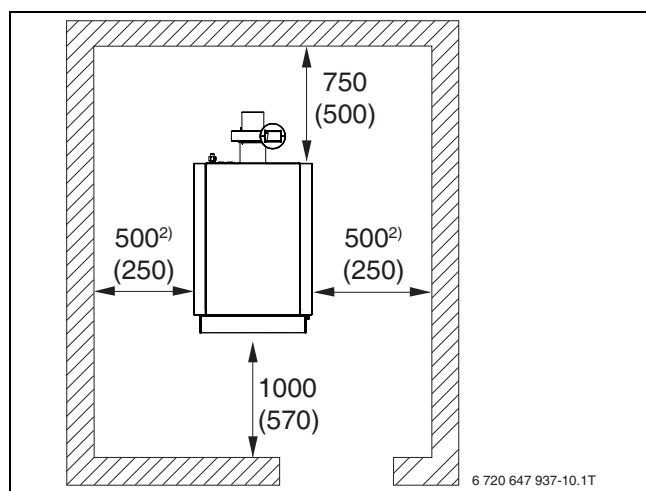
Distanze dalle pareti nel locale di posa<sup>1)</sup>
